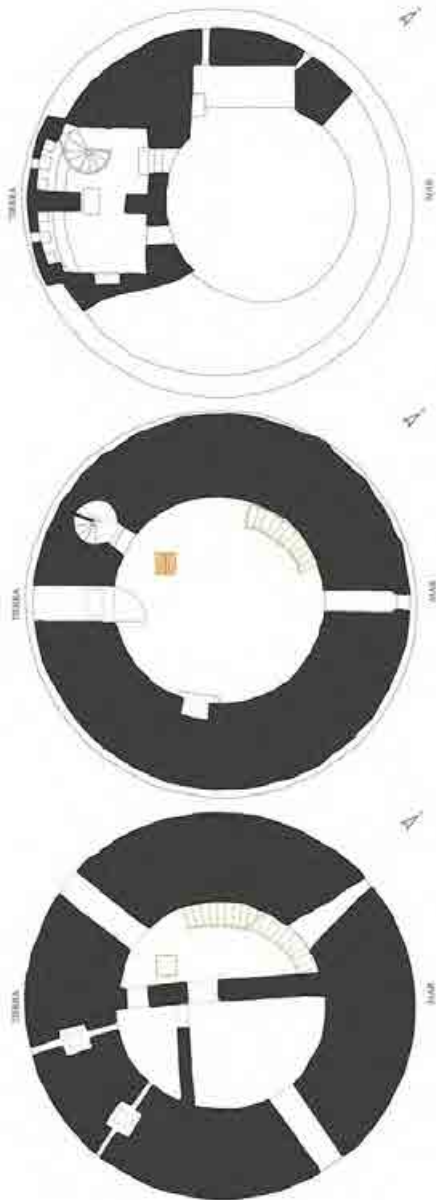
Torre de Alcaufar. Terraza, planta primera y planta baja (Mónica Fernández).
